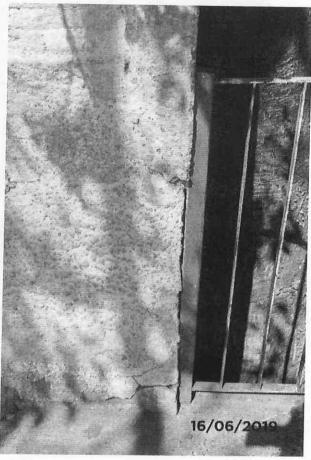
Detalhe da trinca na fixação do guarda corpo e o muro.
